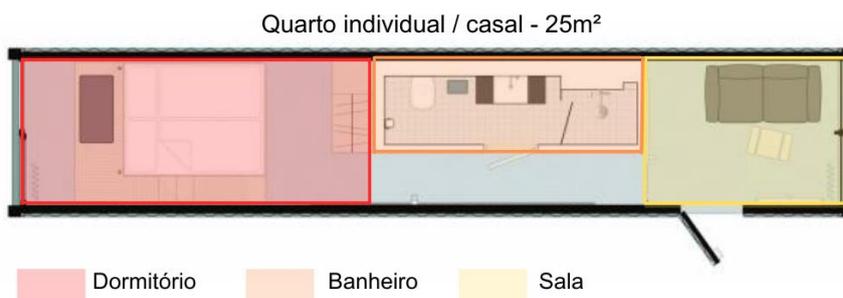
Setorização / Planta baixa quarto individual. Alterado pelo autor.
